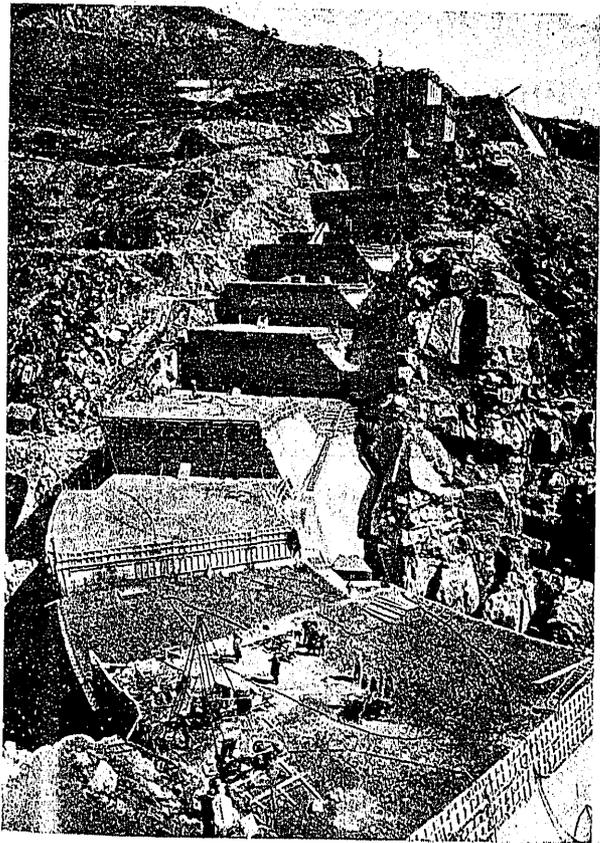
Presa de Belesar. Entronque de la presa con la ladera y el estribo de gravedad en la margen izquierda.
